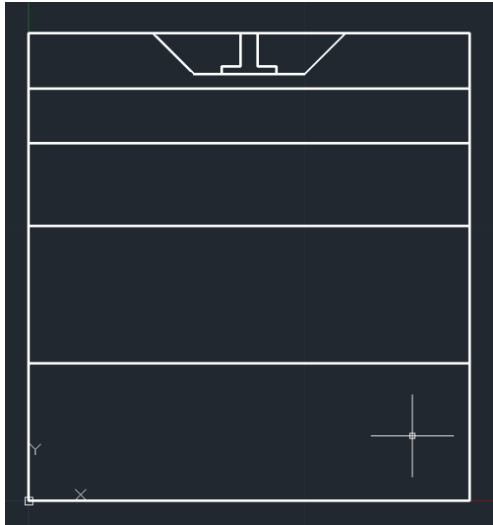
Расчетная схема посадки ленточного фундамента на грунты основания для переноса решаемой задачи в ПК Midas GTS NX, выполненная в AutoCAD
